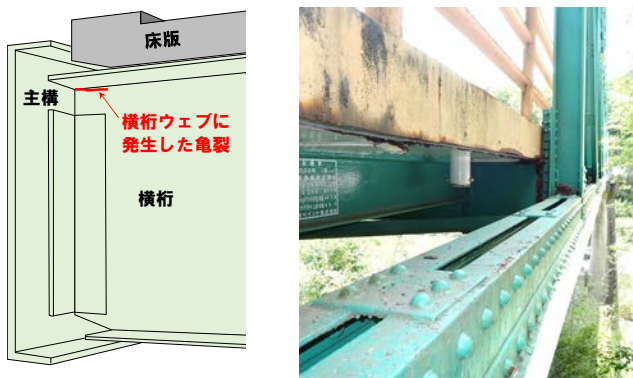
亀裂発生状況 写真-1 実橋の主構と床版
